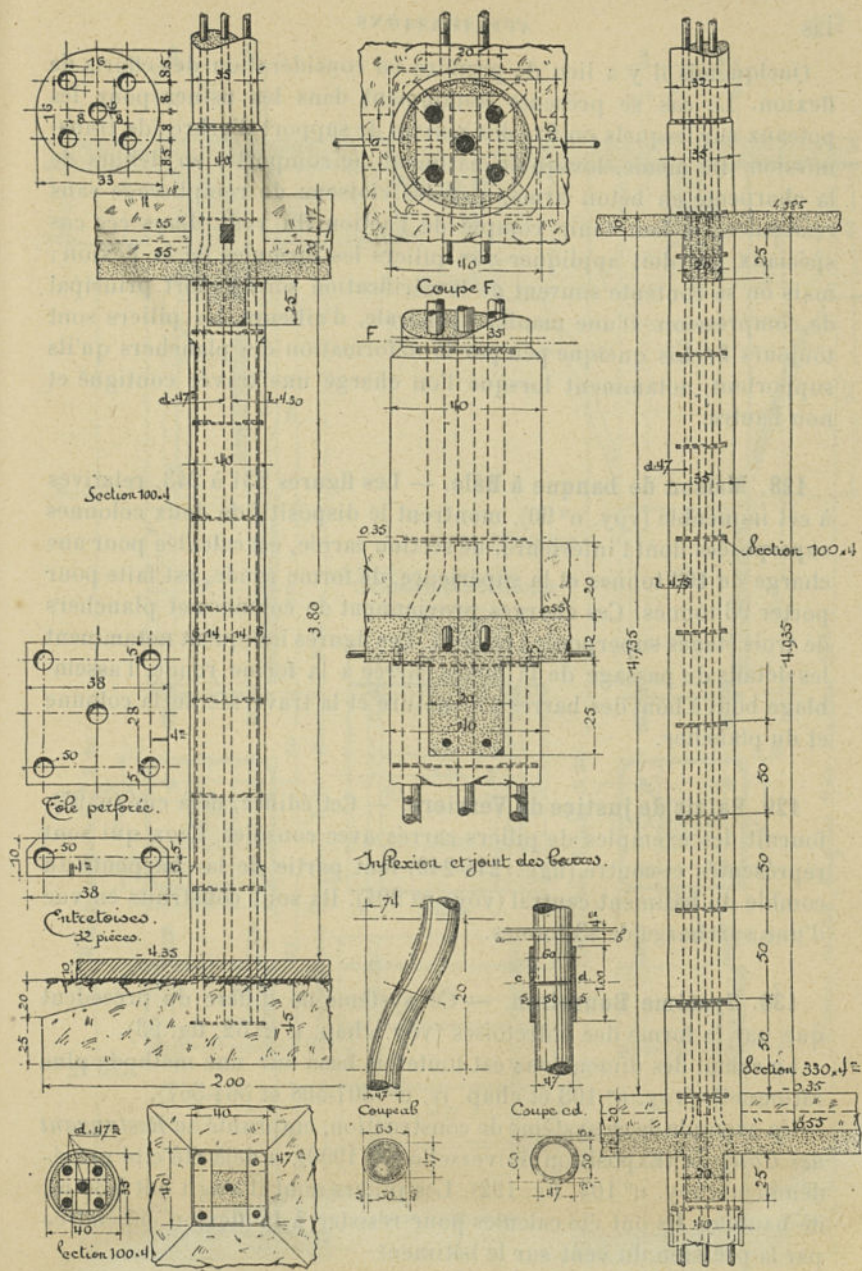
Maison de banque à Bâle. Colonnes de la cave et du rez-de-chaussée.
